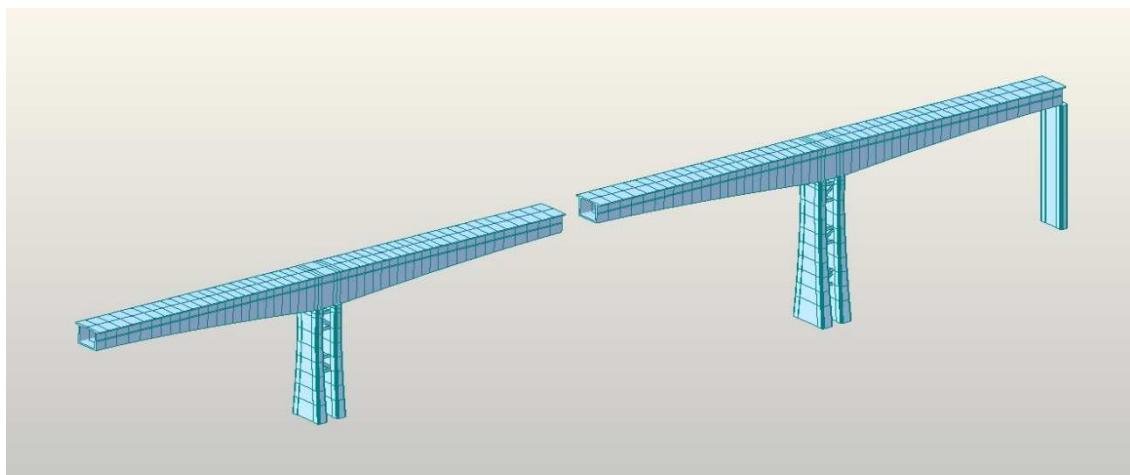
Fáze 3 - Vybetonování zárodku na pilířích
